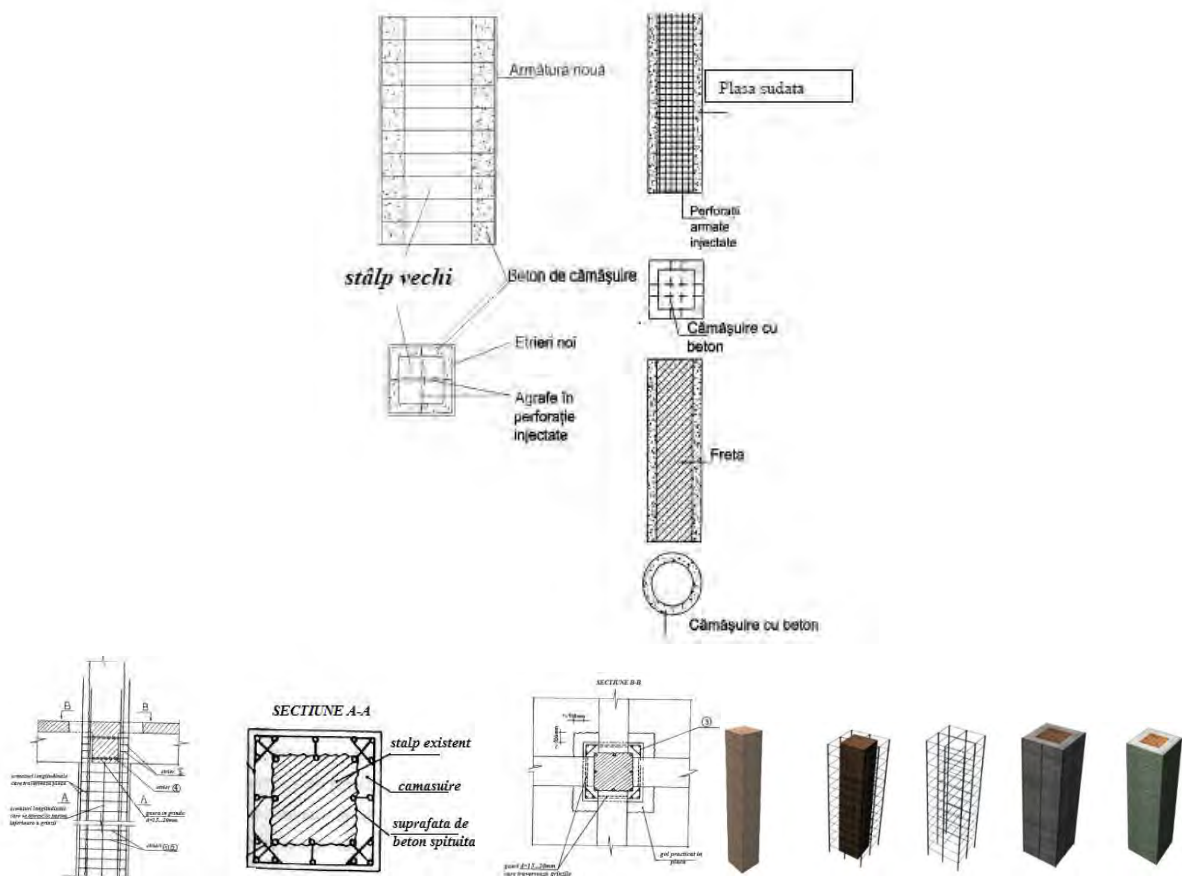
Consolidarea stâlpilor din beton armat cu cămășuiala pe patru laturi [76]
